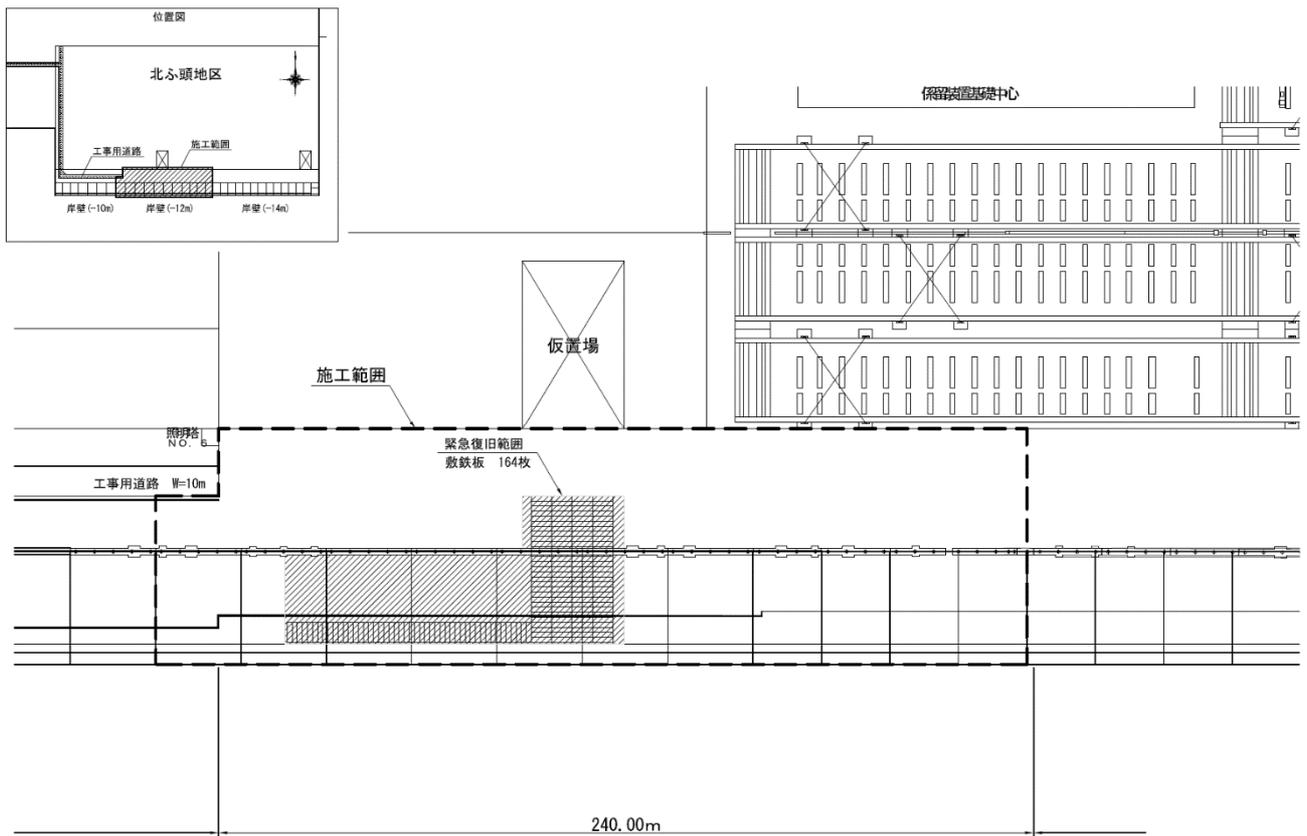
No.5 常陸那珂港区_北ふ頭岸壁(-12m)の平面図 (被災後)
